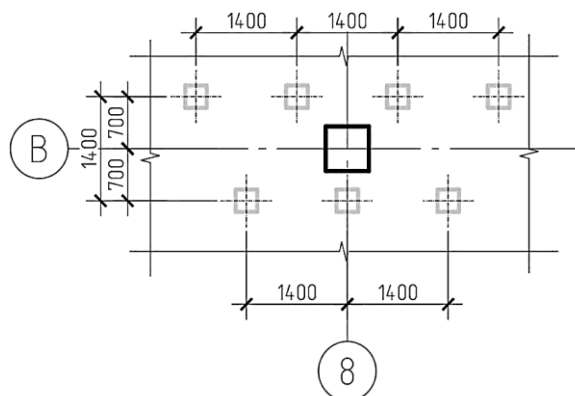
Схема розташування паль під фрагмент плитного фундаменту
